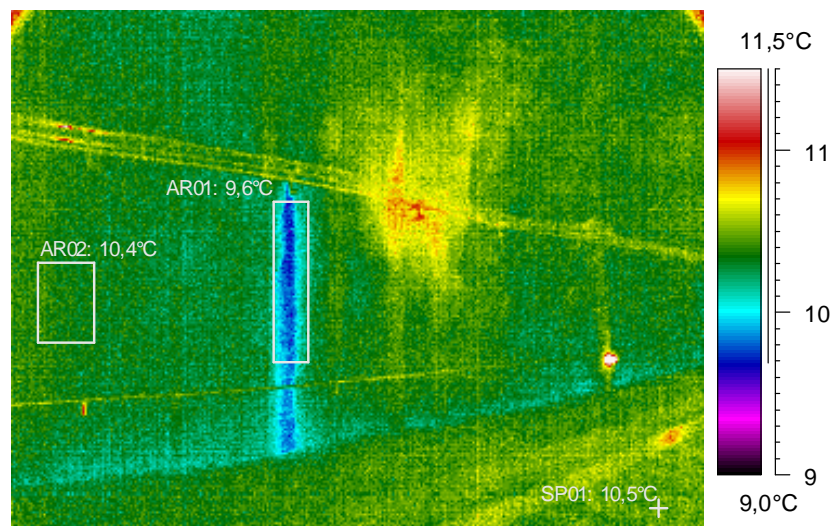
Katossa tuoreet levyjen saumanauhoitukset ja pilarissa tuoreet tasoitteet [29].
